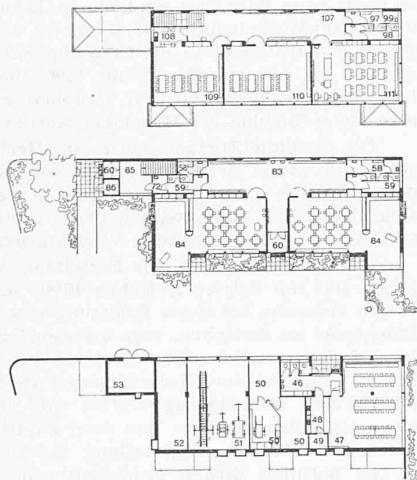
bis 23. Grundrisse des Kindergartengebäudes 1 : 800
